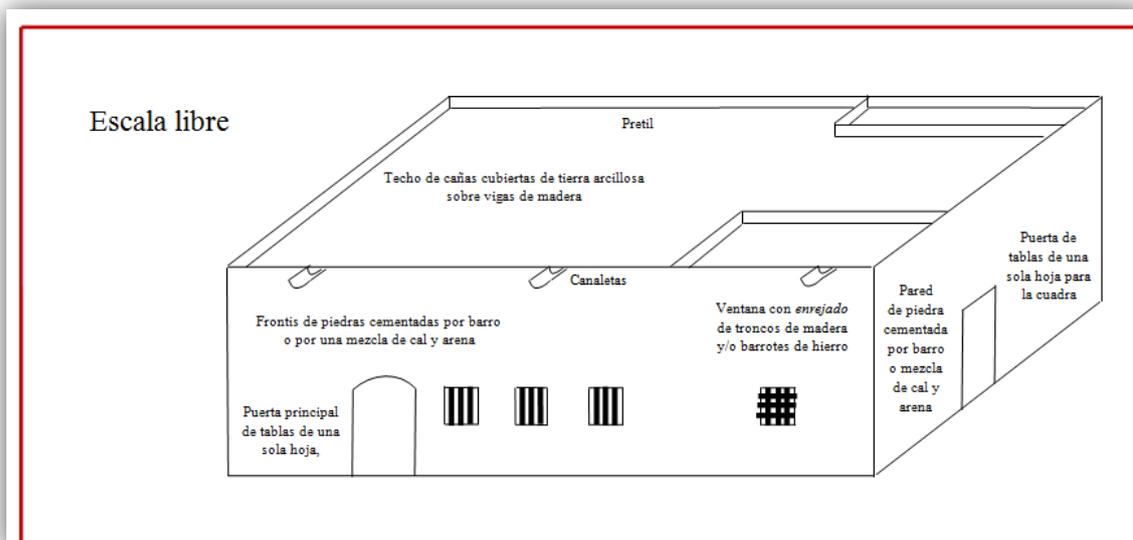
alzado de las fachadas frontal y lateral de un cortijo tipo del Campo de Níjar (Almería). Los cortijos con las paredes externas de piedra y barro, sin revestir, se mimetizan con el territorio, y no imprimen el rasgo cultural impuesto del “blanco” del cortijo andaluz en el Campo de Níjar. Esto ilustra la incidencia morfológica de la tipología edificatoria en su marco geográfico
